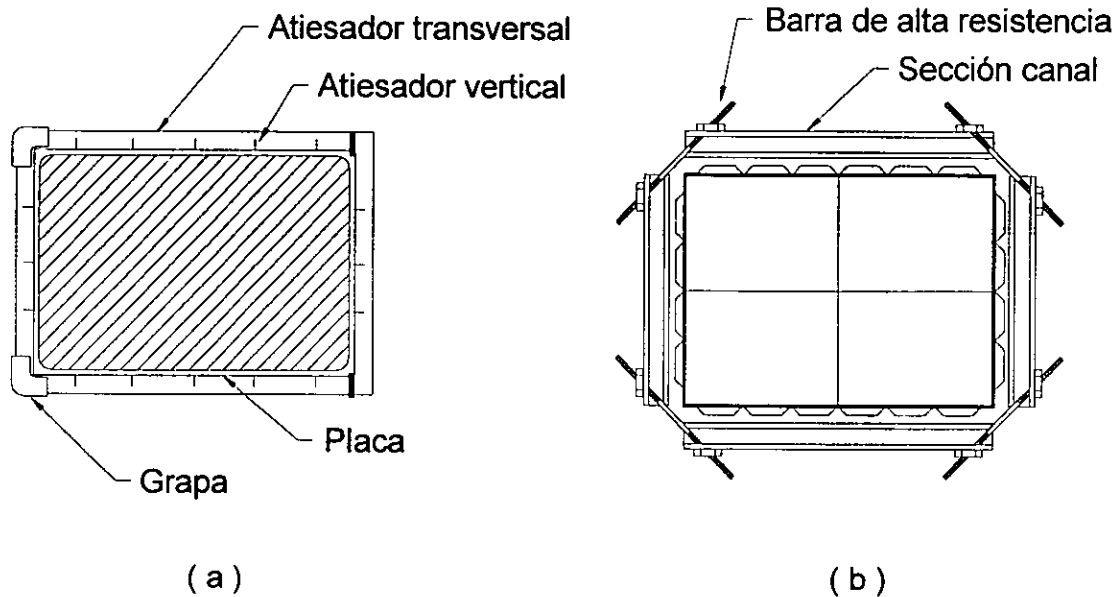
a) Columna con camisa rectangular de acero atiesada y b) columna con camisa formada con canales de acero
